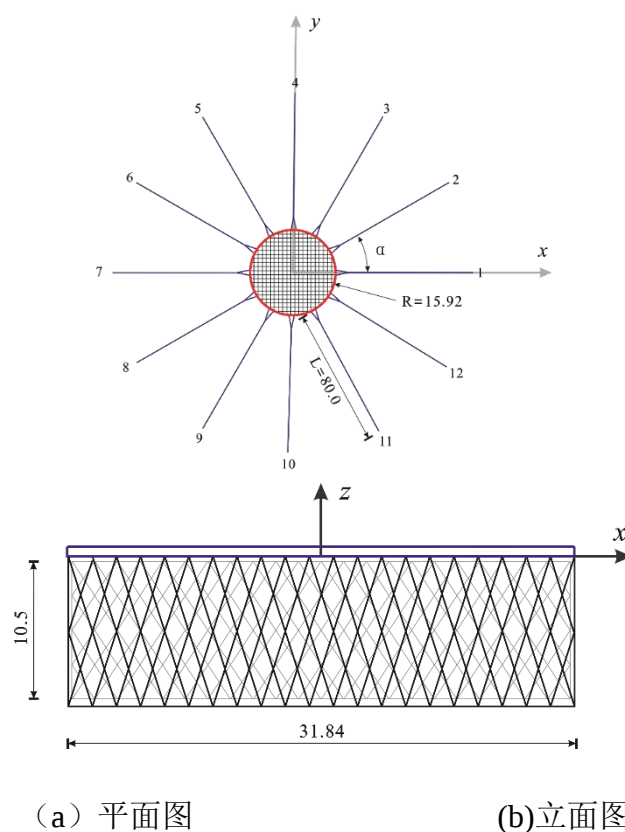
网箱及其系泊系统布置示意图（单位：米）
